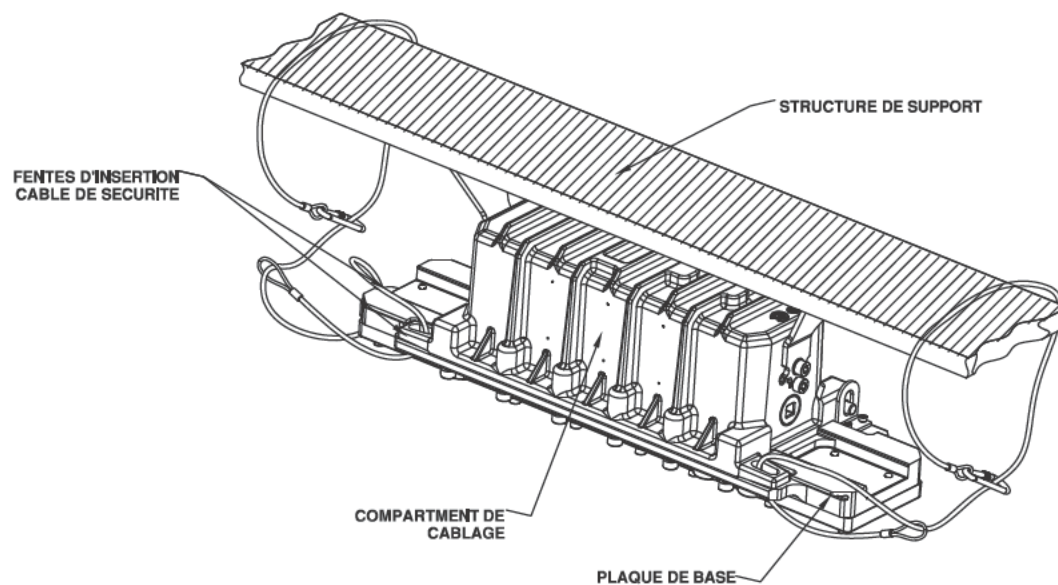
ERM_RIGMASTER D'URGENCE - ERM: 4 PIEDS. LUMINAIRE AVEC CABLES DE SURETE
